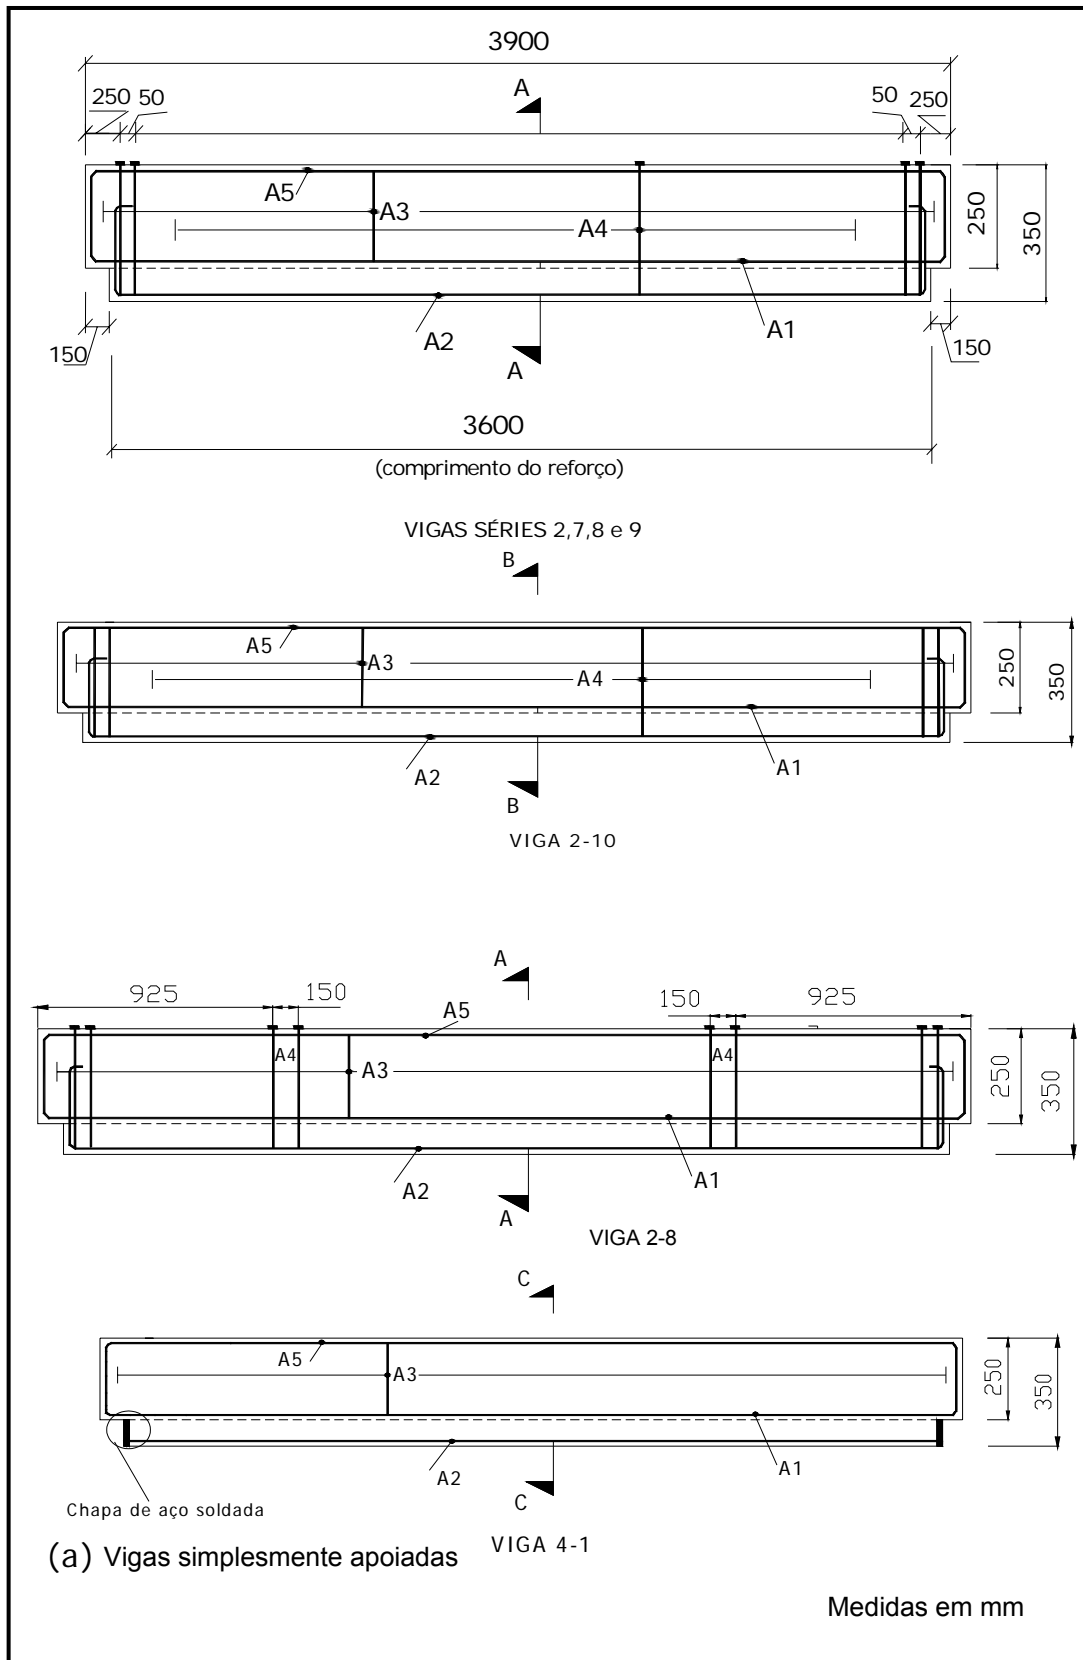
Armaduras das vigas de CHEONG e MACALEVEY (2000)
